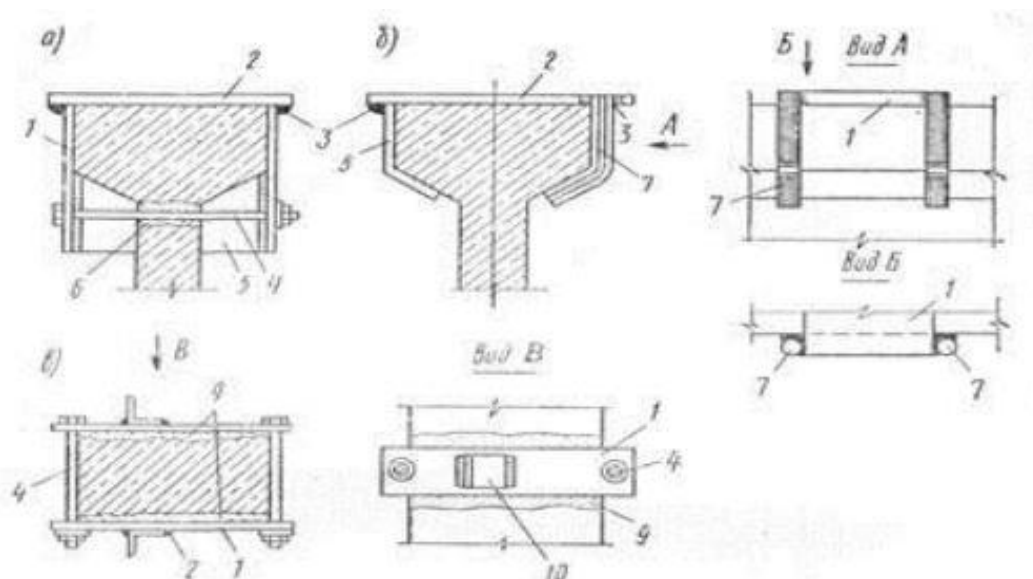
Установка дополнительных закладных деталей с помощью хомутов: а — хомут из листовой стали на болтах; б — то же, с держателем из листовой стали; в — то же, с держателем из круглой стали; 1 — боковые планки хомута; 2 — лицевая планка хомута; 3 — сварные швы; 4 — стяжной болт; 5 — ребра жесткости; 6 — отверстие в стенке балки для пропуска стяжного болта; 7 — стержневой держатель; 8 — листовой держатель; 9 — борозда, пробитая в поверхности бетона и заделанная впоследствии цементным раствором; 10 — уголок для крепления дополнительных элементов
